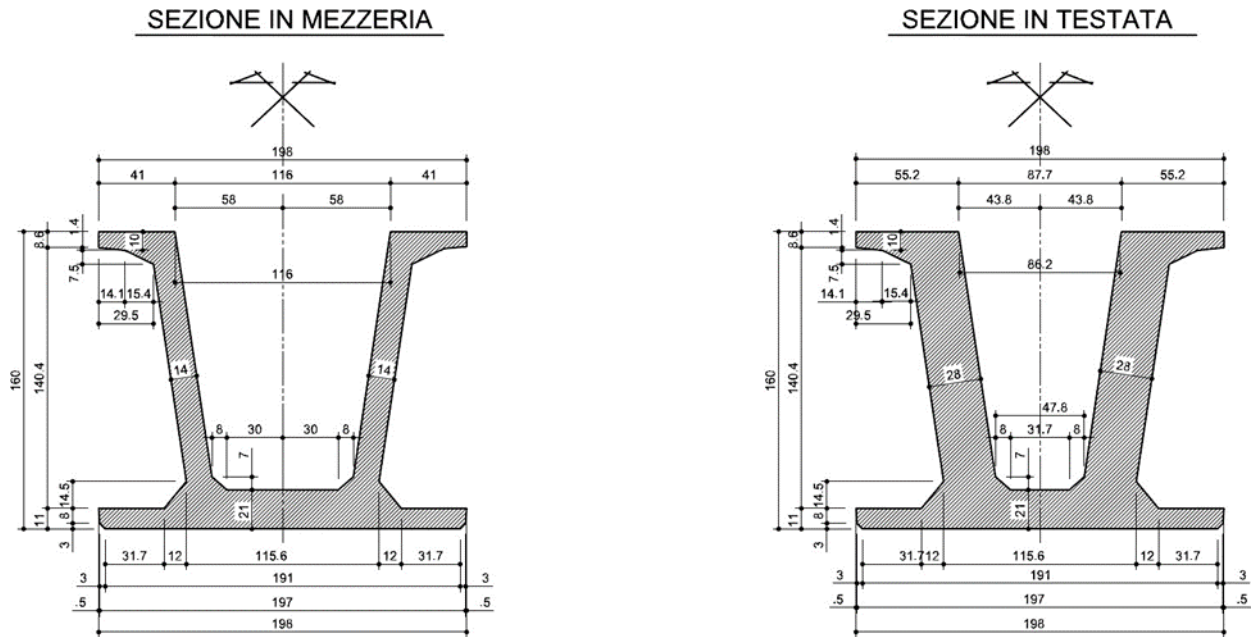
Sezione trasversale trave “tipo CIR” 198/160/14-28cm
